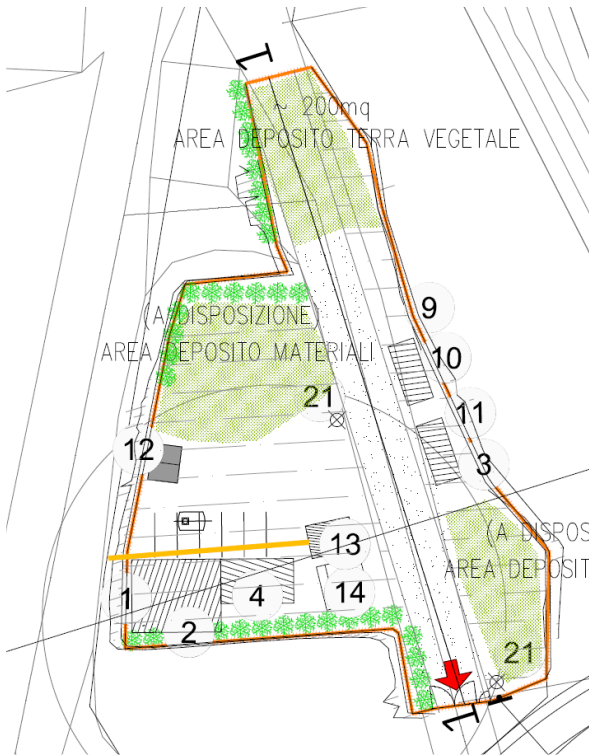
Viabilità di Rione Borgato - Layout cantiere operativo 3
